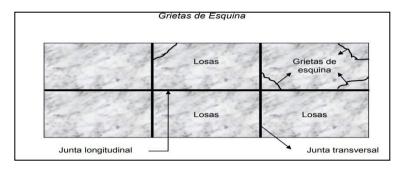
Falla por fisura en esquina de Pavimento Rígido
